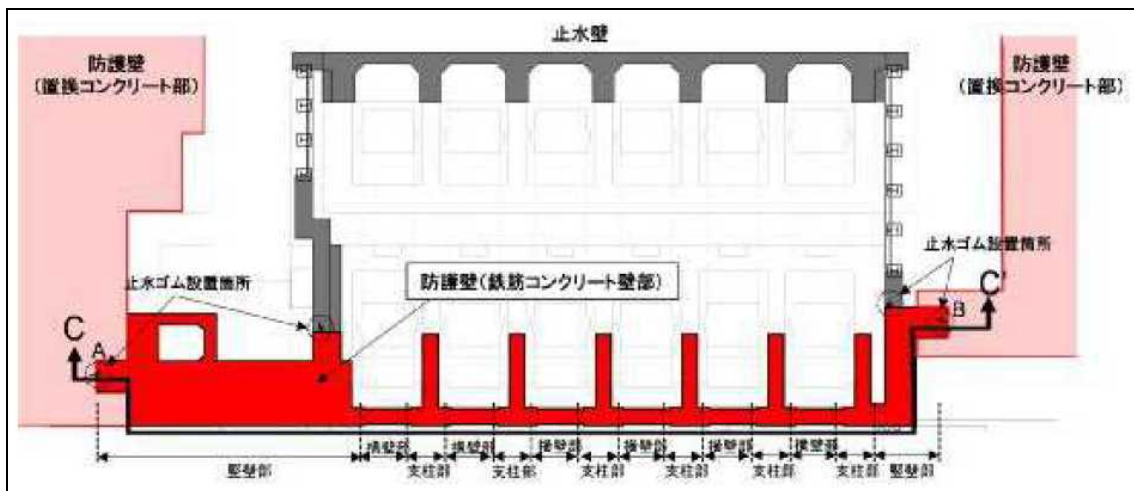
防護壁平面図 (鉄筋コンクリート壁部拡大) (関西電力 大飯 3, 4 号炉)
